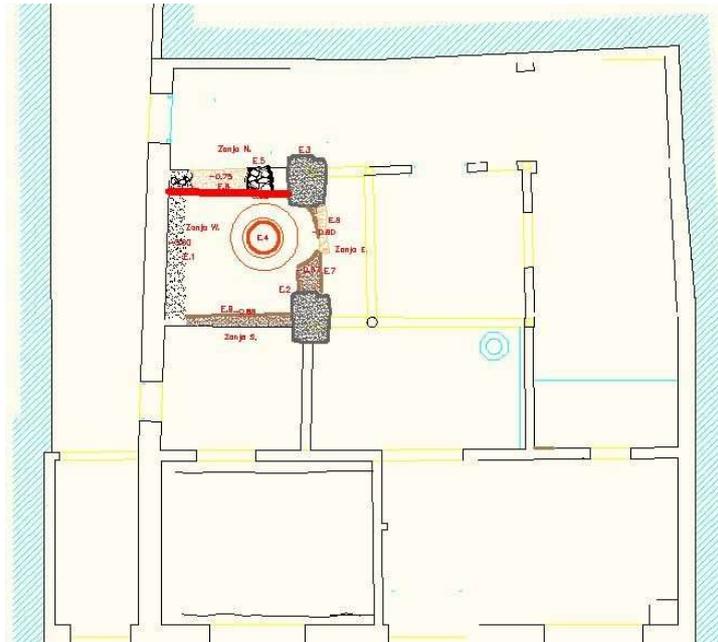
Línea roja, localización del perfil Sur de la Zanja Norte.
